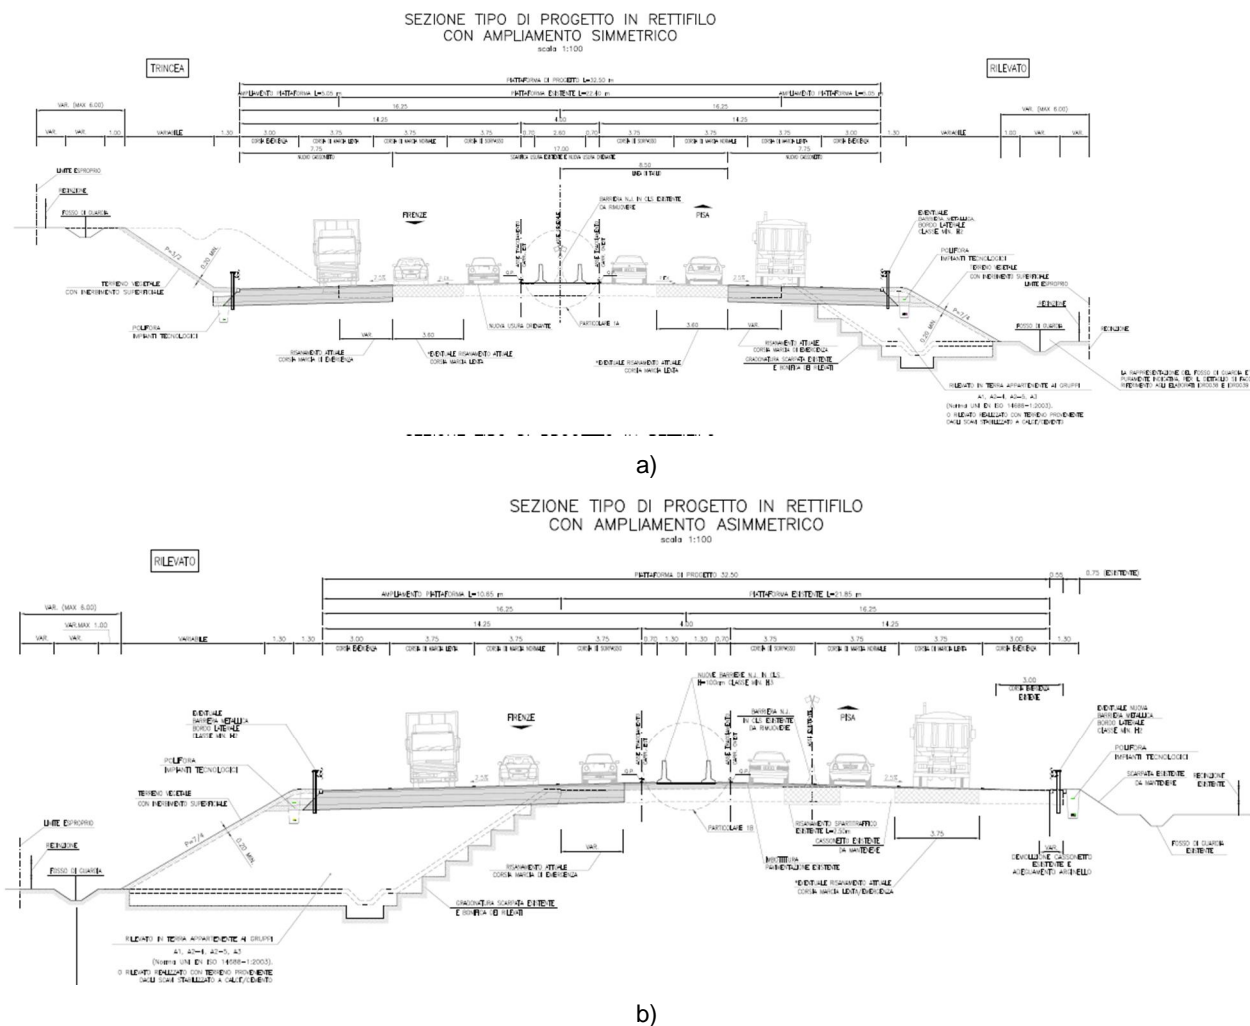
Sezione tipo autostradale ampliamento in rilevato: simmetrico a); asimmetrico b).
